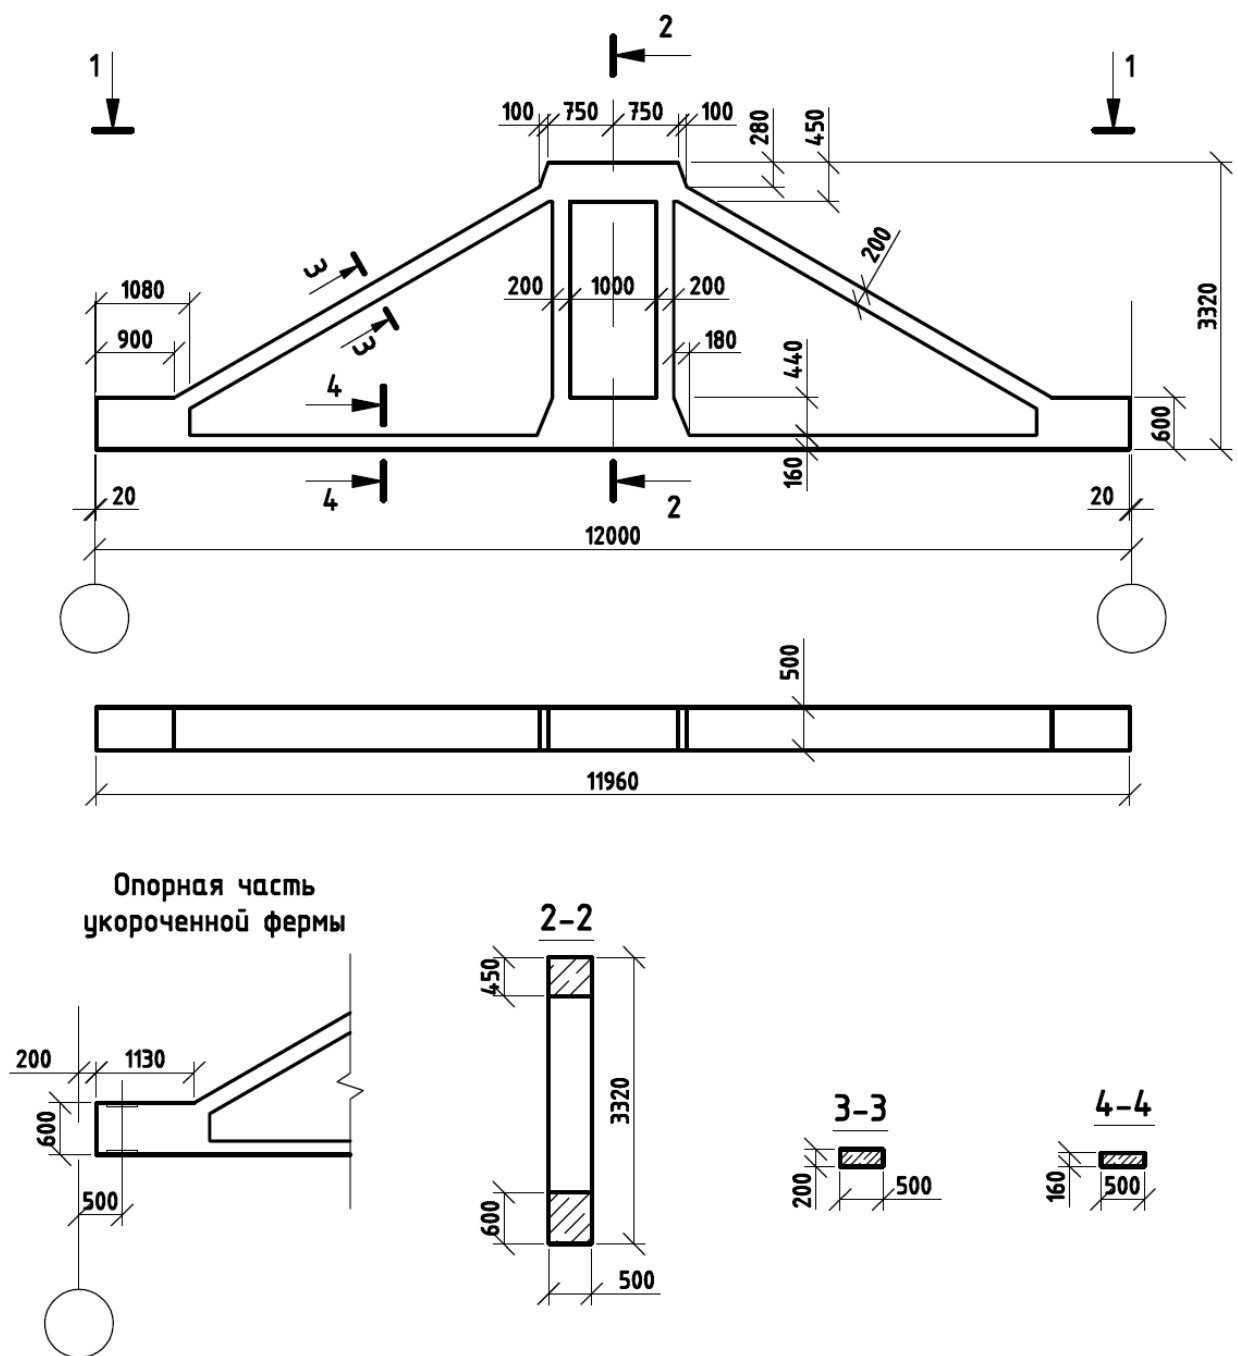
Подстропильные фермы для зданий с малоуклонной кровлей.
